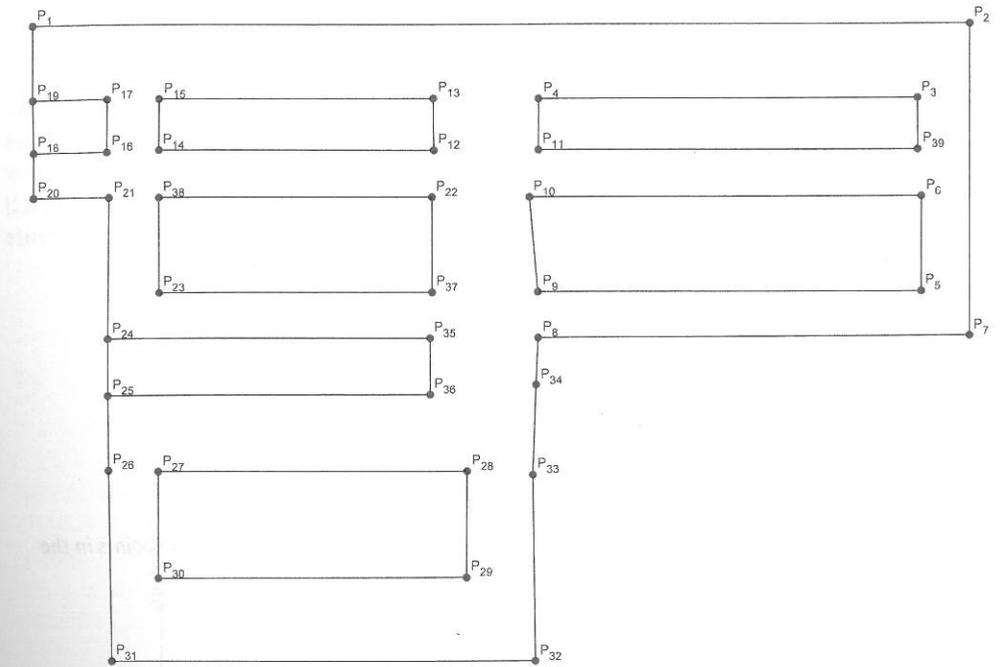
Eingemessene Kalibrierpunkte im Stallgrundriss (Koordinatensystem)
